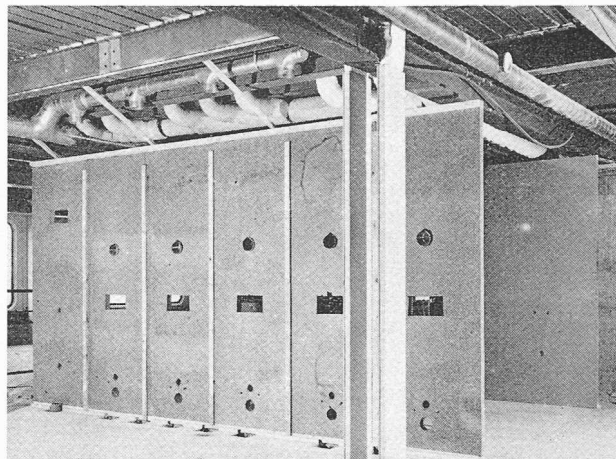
Panneaux en aggloméré avant le montage des installations sanitaires.
